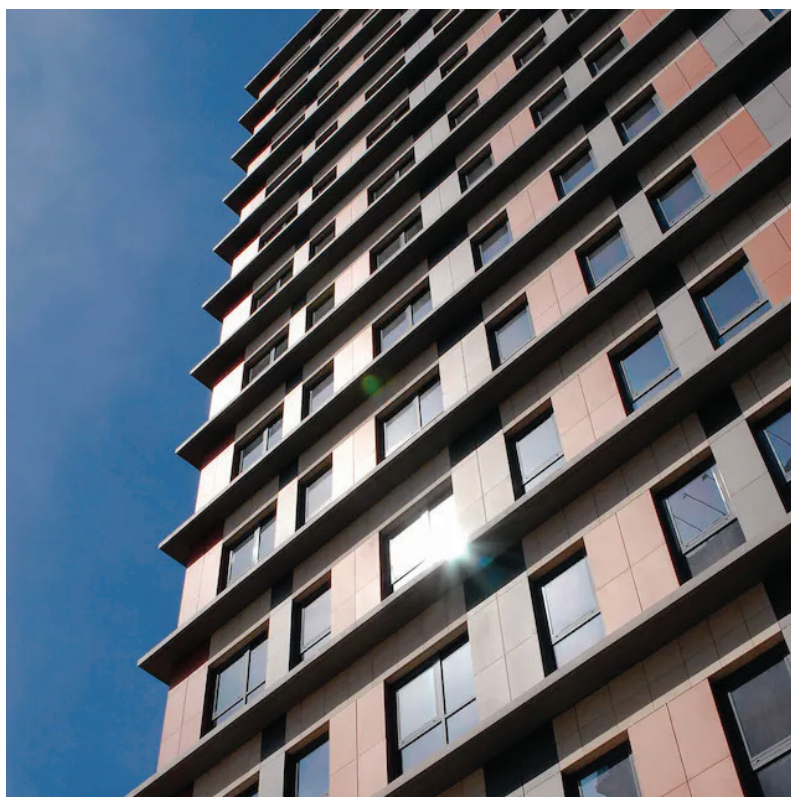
• Fachada ventilada com revestimento cerâmico
